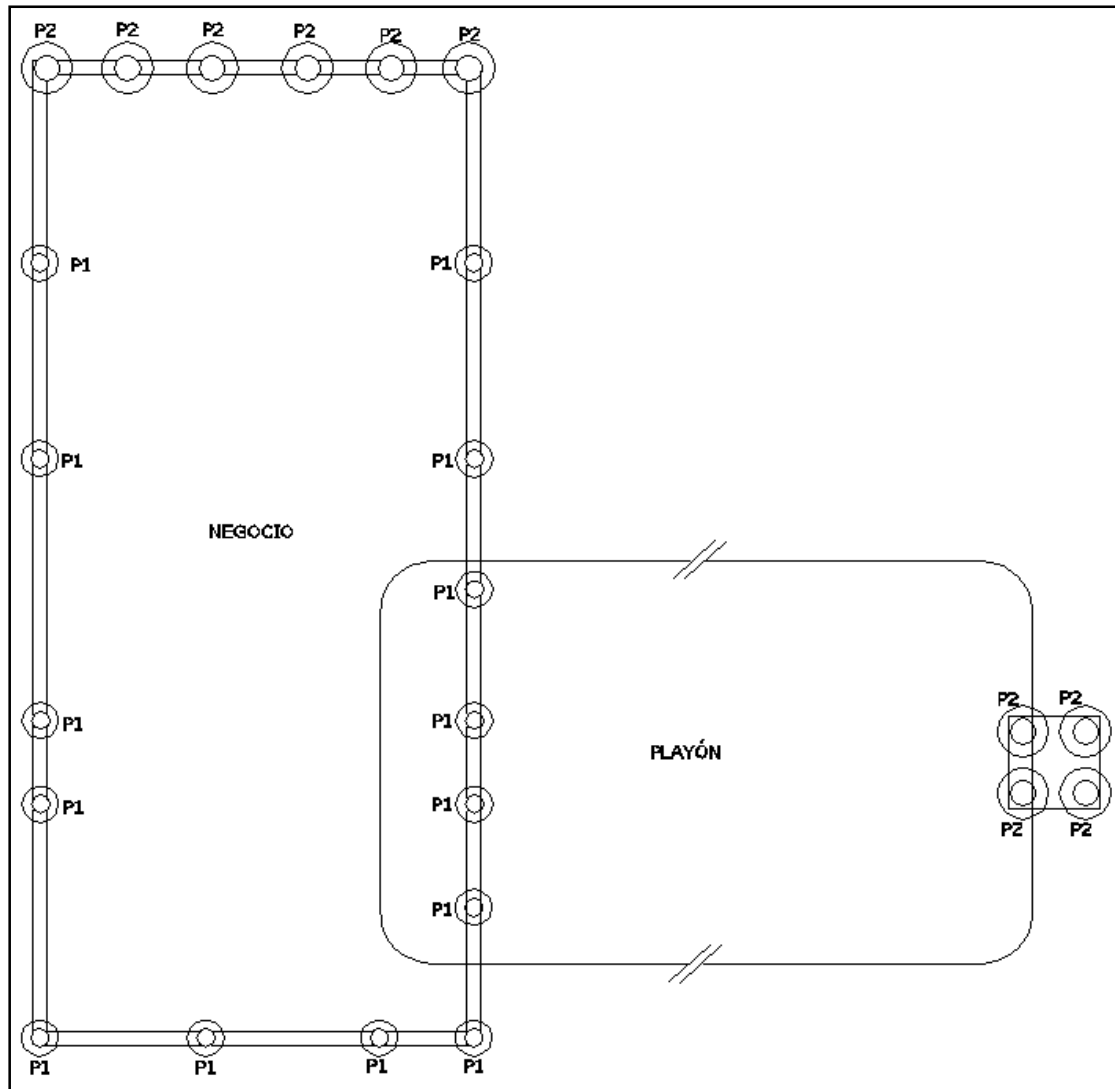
Imagen acotada del plano donde podemos ver la disposición de los pozos.
